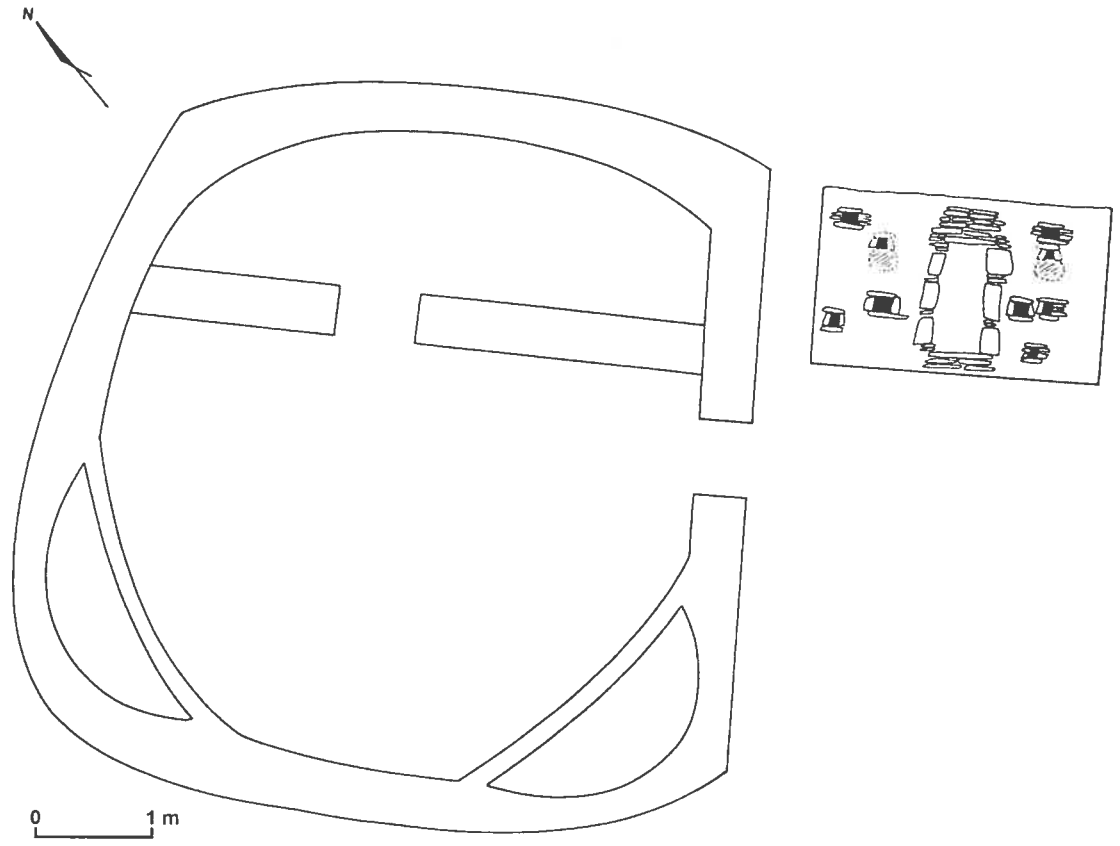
Plan de l'habitation E de type Rapayan à toit plat du secteur II du site # 43 de Wata, zone de Singa.
